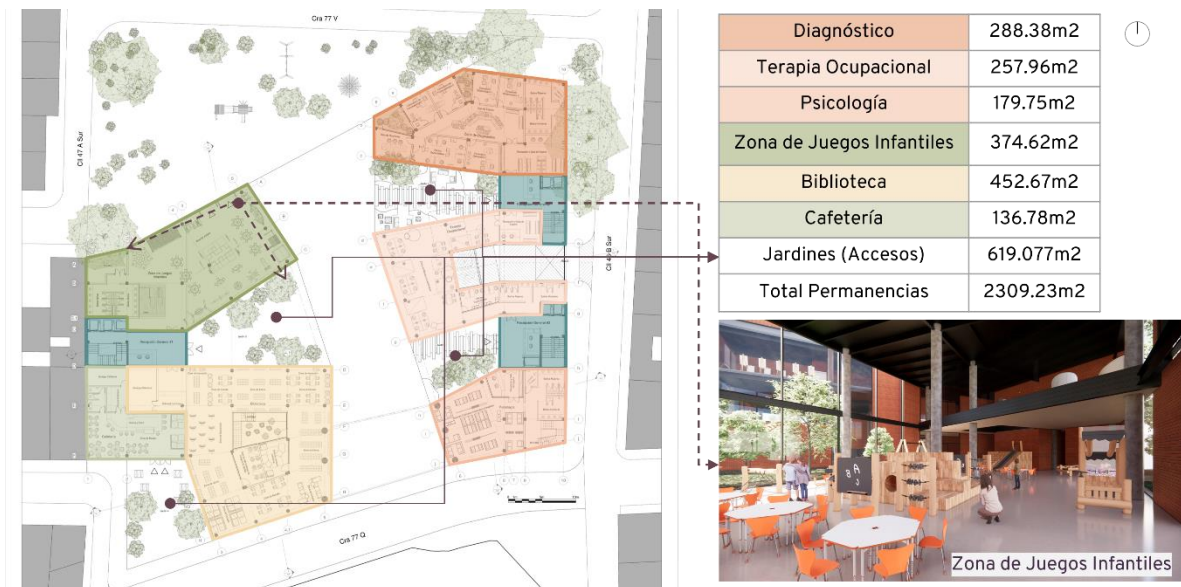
Planta de acceso con actividad. Fuente: Elaboración propia
